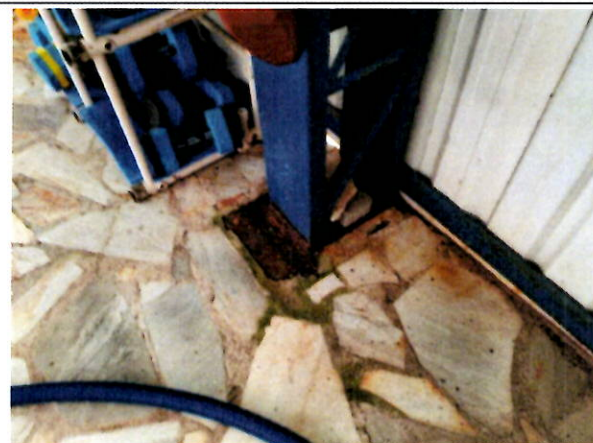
Oxidação da base dos pilares da estrutura metálica que apoia a cobertura
